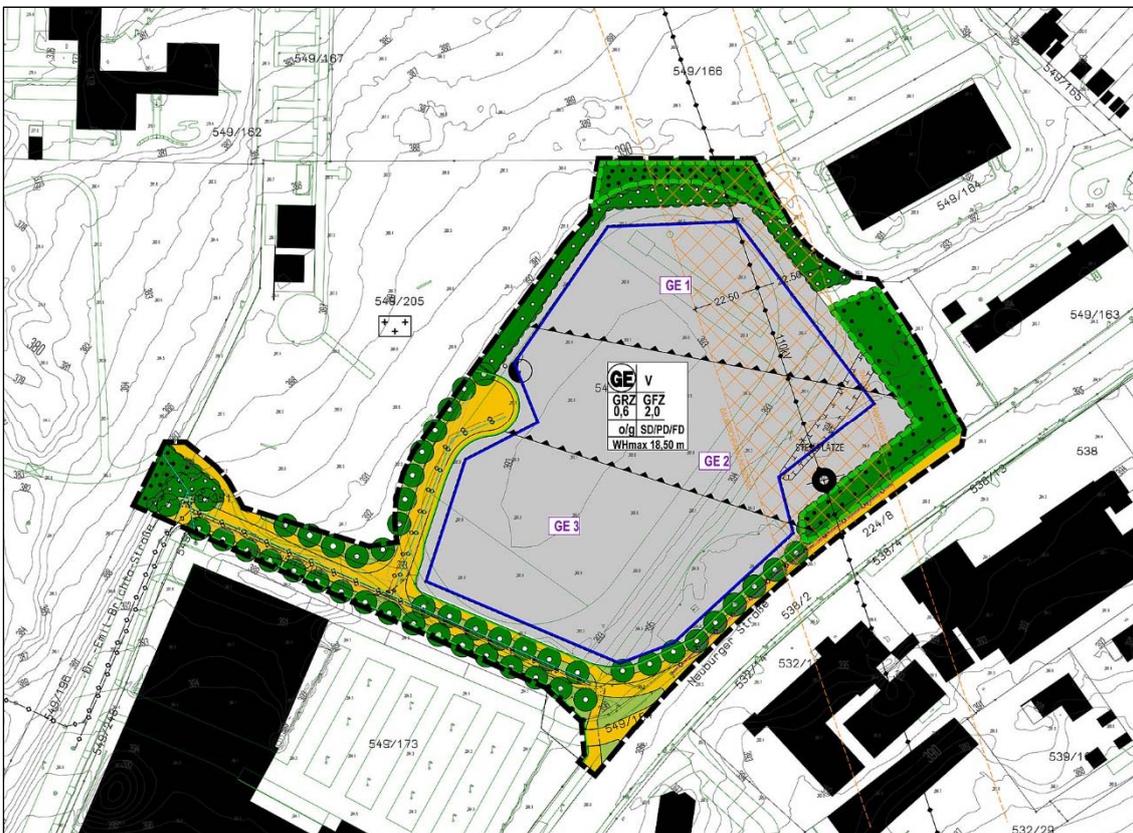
Planzeichnung zum Bebauungsplan "Ehemaliges Bundeswehrgelände P9" /14/
